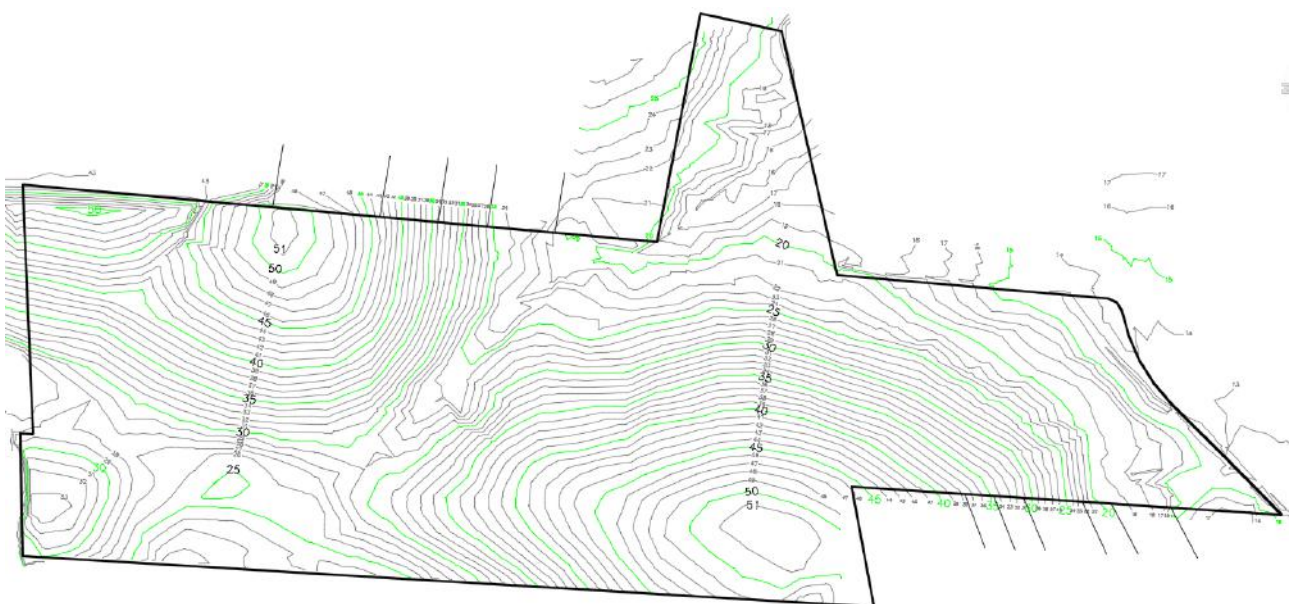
Perímetro do terreno demonstrando as cotas existentes.
